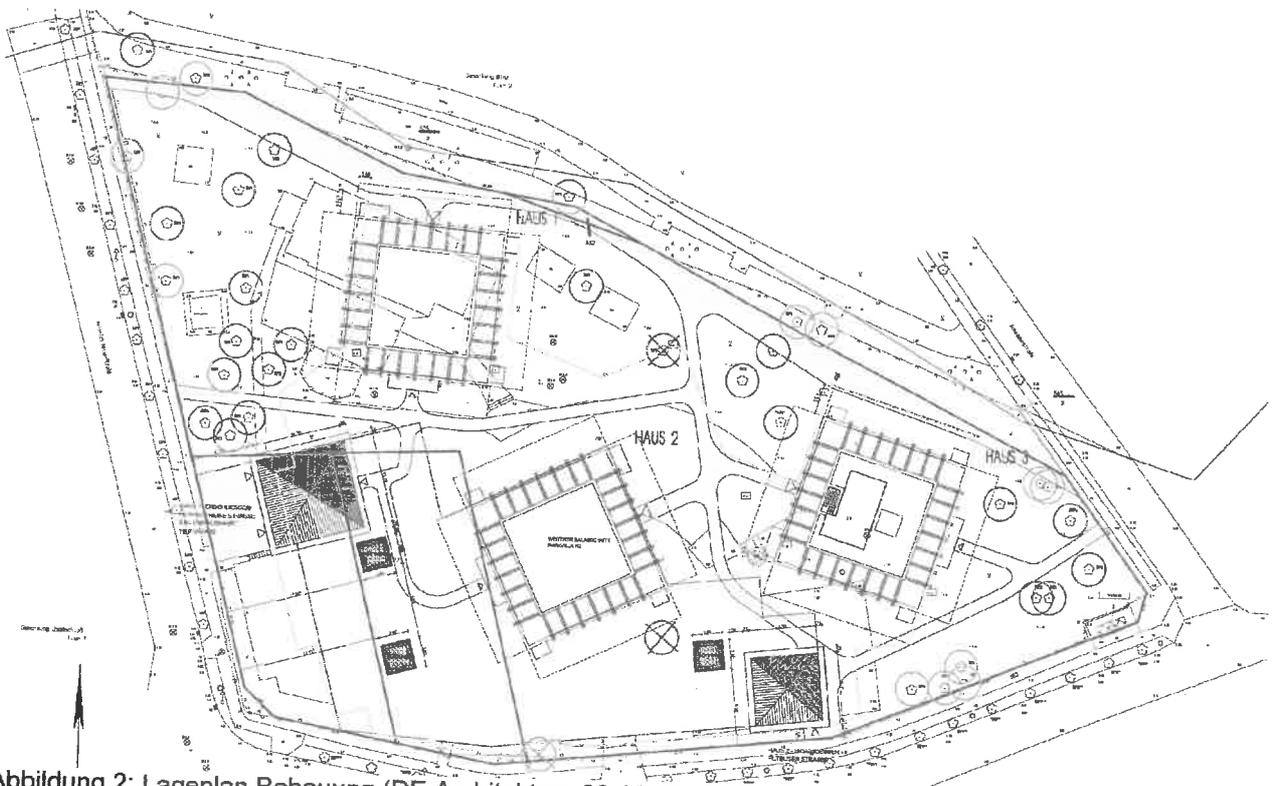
Lageplan Bebauung (DE Architekten, 08.10.2012)
